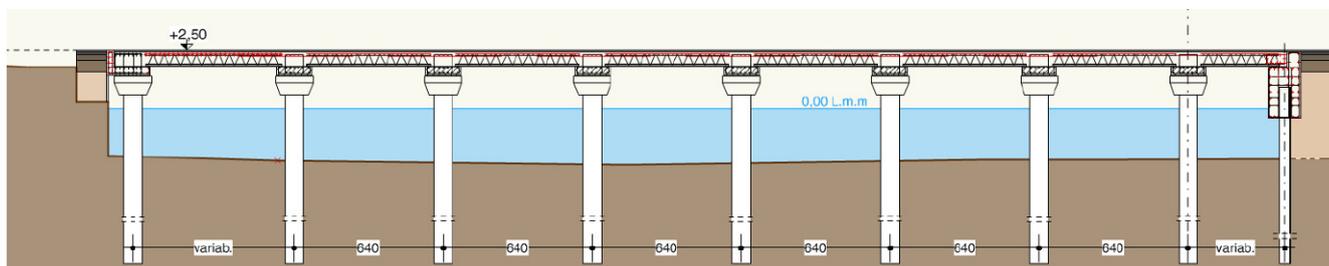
Ampliamento Fossamastra: sezione trasversale di progetto della banchina a giorno
